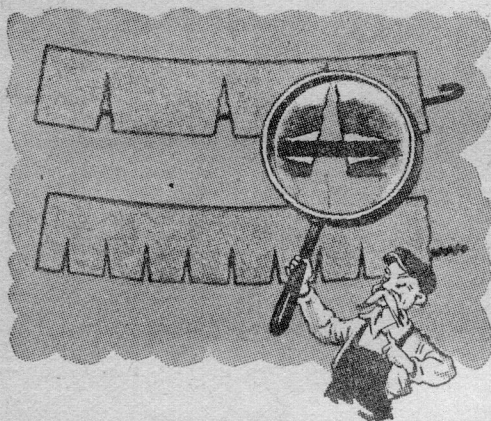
在用光面鋼筋配筋的鋼筋混凝土構件中，裂縫間隔很远，开展得也很寬。这时裂縫兩边鋼筋和混凝土之間的粘着力就破坏了。使用規律变形鋼筋时裂縫較密，开展較小。因此在第二种情况下，鋼筋混凝土構件的承載能力要大些。
